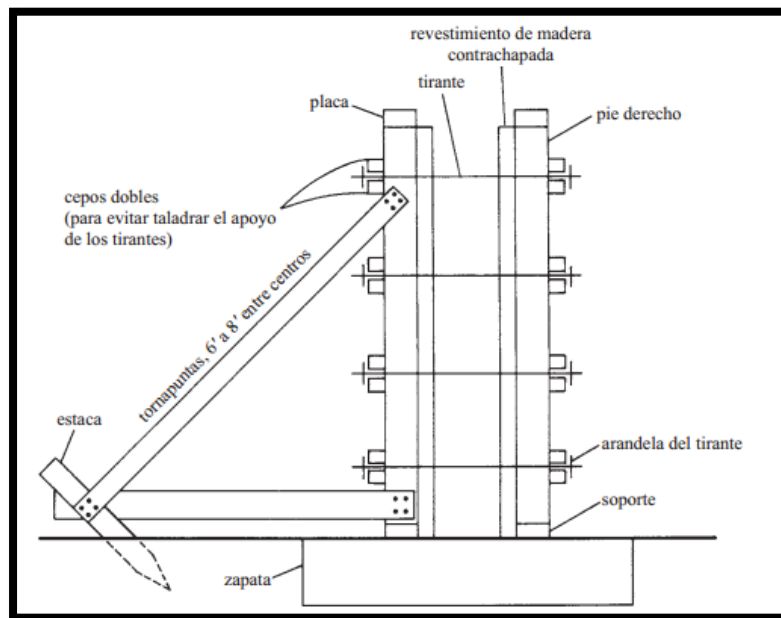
Detalle de encofrado para muros de concreto reforzado
